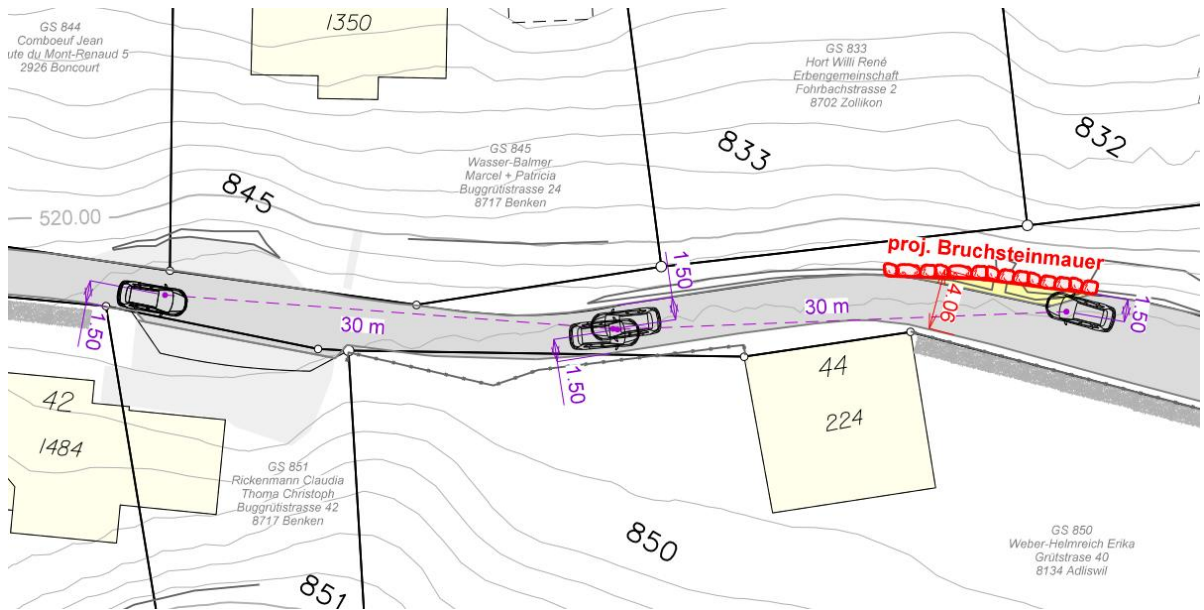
Ausschnitt Plan Nr. 9000.95-011, Situation Ausbau Buggrütistrasse, Erweiterung Ausweichstelle
